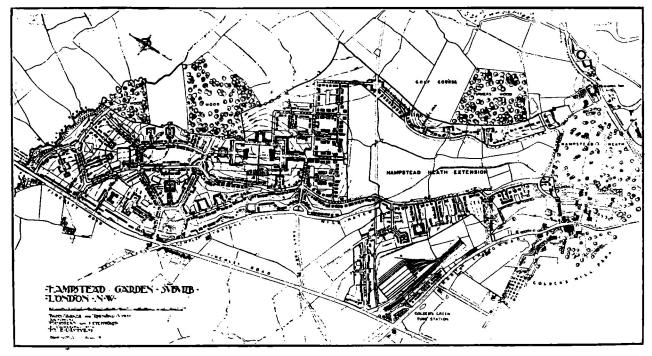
Plano general de la Ciudad-jardín de Hampstead, en los suburbios de Londres.
